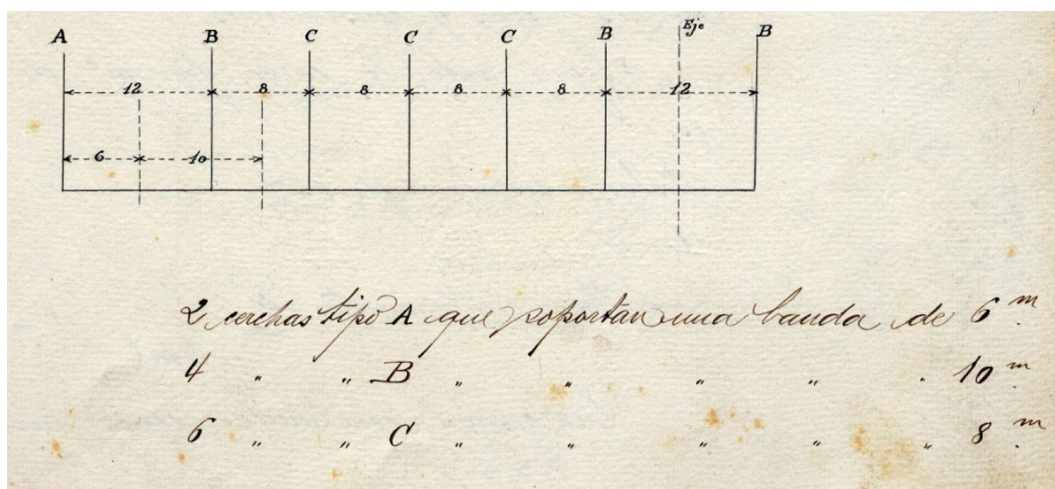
“Estación definitiva de Sevilla (San Bernardo). Parte metálica. Cubierta delante del edificio de viajeros”, detalle de las cerchas
